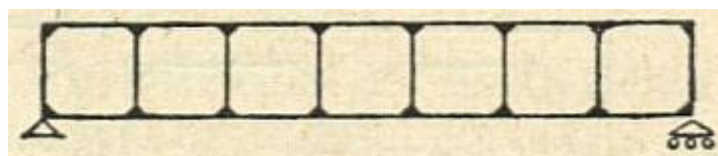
Modelo de cálculo da viga Vierendeel [28].
